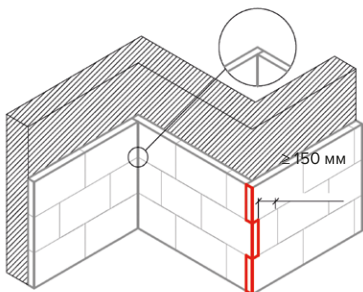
Зубчатая перевязка плит на внутренних и наружных углах здания
